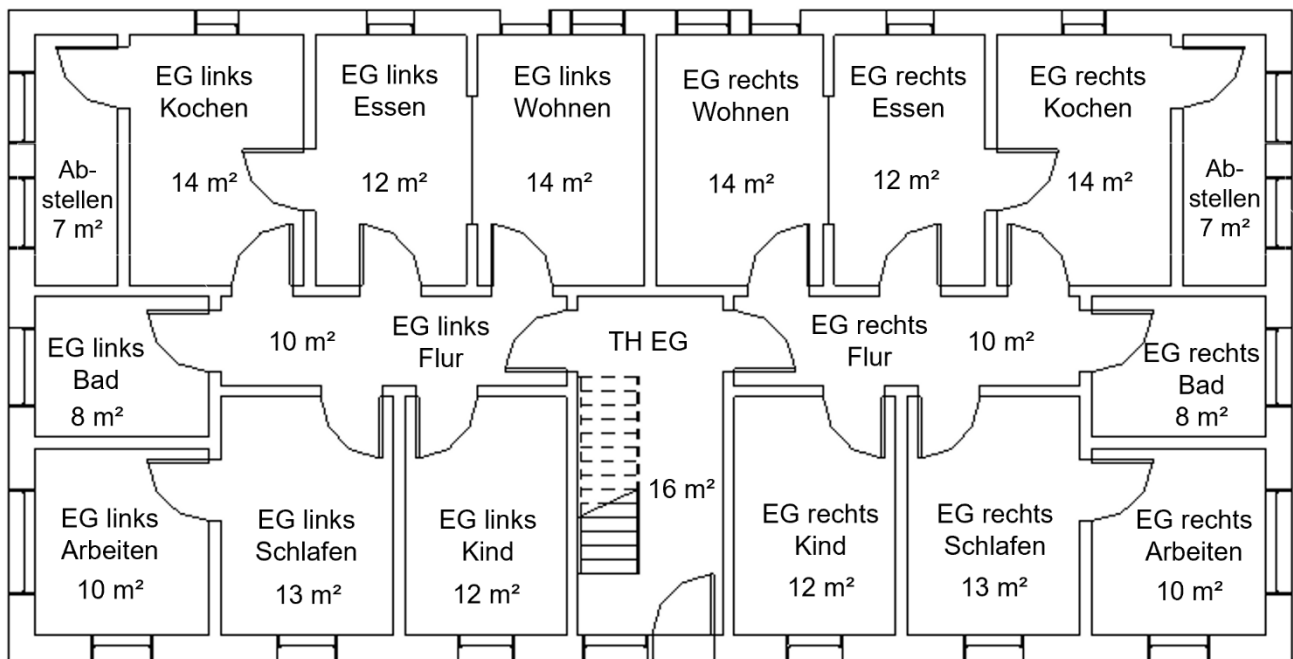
Grundriss Erdgeschoss des Archetyps MFH
